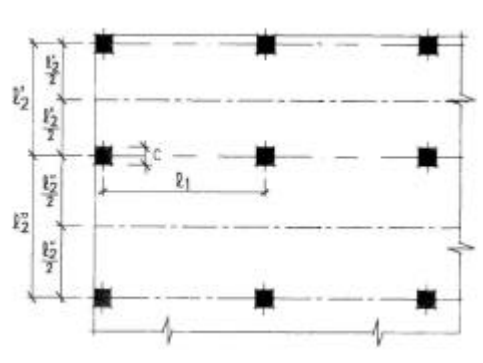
Geometría para el cálculo de la sollicitación de torsión.
